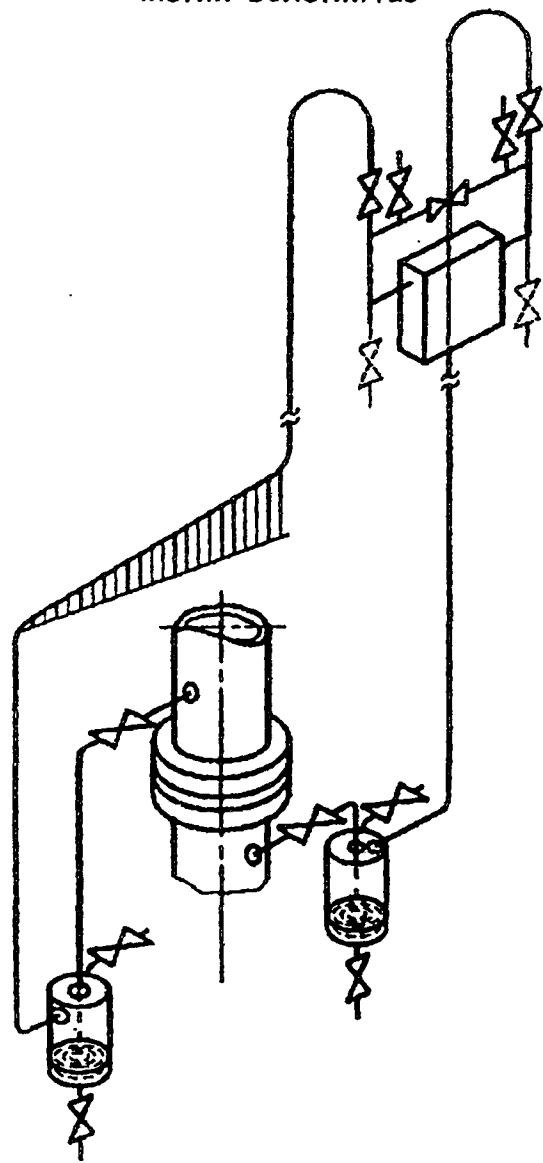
ППТ над трубопроводом (два варіанти)
